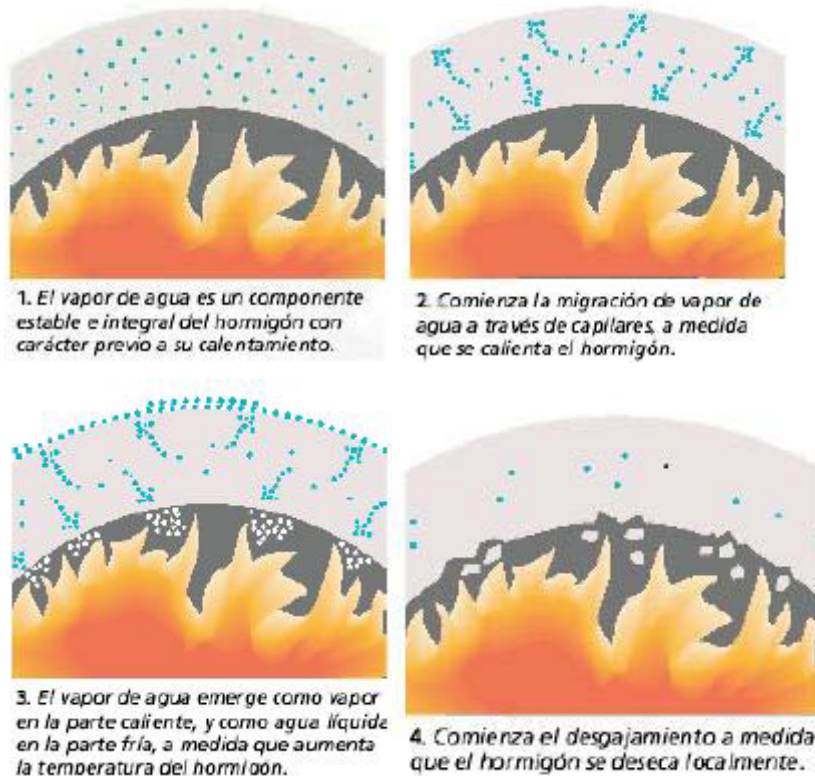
, efecto de descascaramiento (spalling) en el concreto
